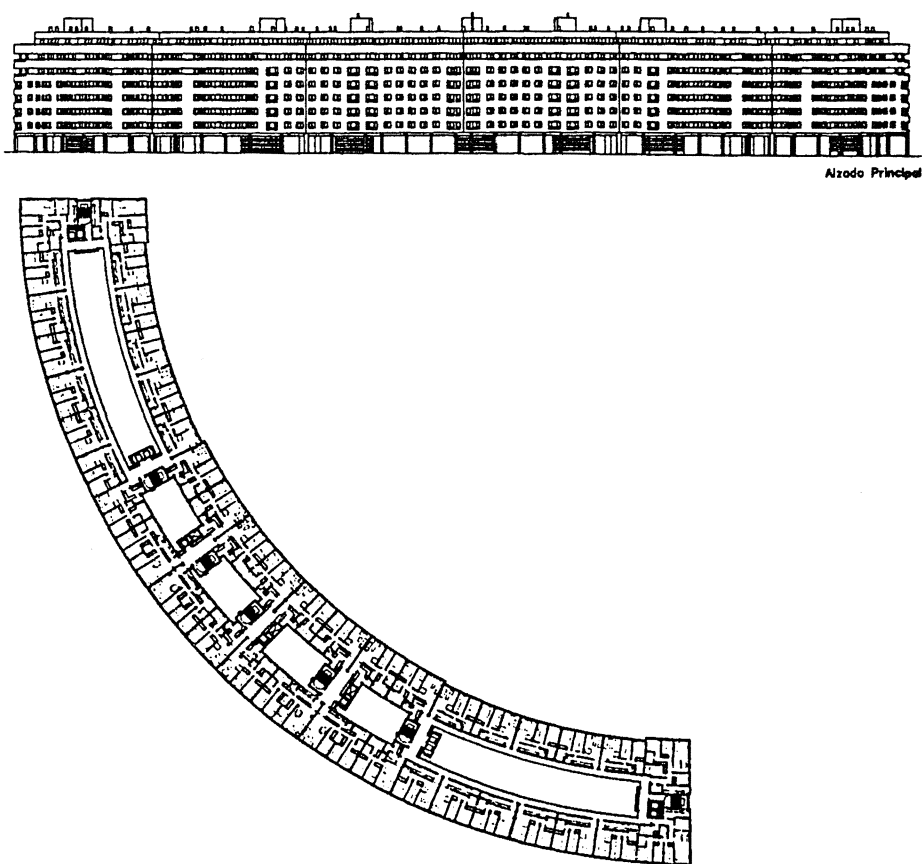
Vivienda con patio en galería en Loranca «Ciudad Jardín», Fuenlabrada, Viviendas VPO. Proyecto de Yleón, Arquitectura y Urbanismo, S.L.
